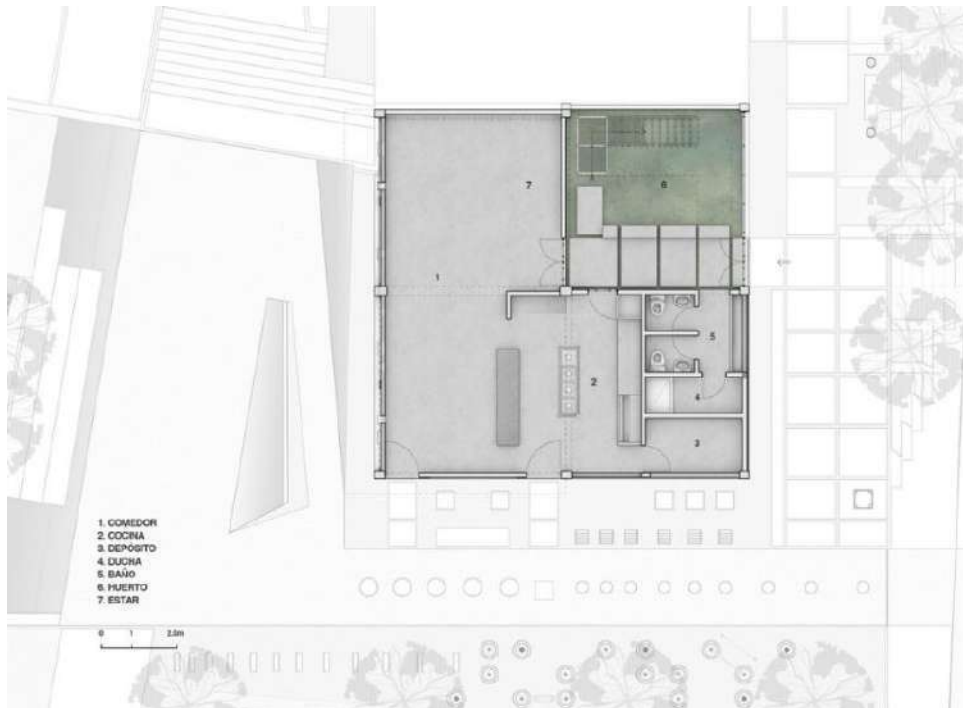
/ Planta: Primer nivel (Proyecto Fitekantropus)
